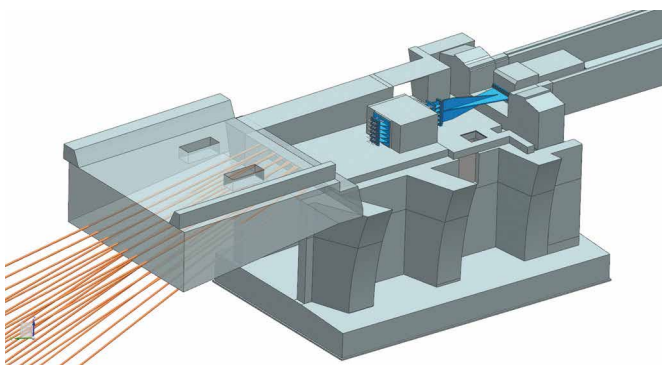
Bemessung und Bewehrungsführung T-Knoten
